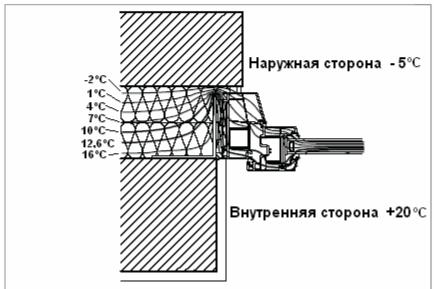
Бетонная стена с кладкой и вентилируемой зоной изоляции, окно из профиля ПВХ типа "моноблок" в зоне изоляционного слоя
